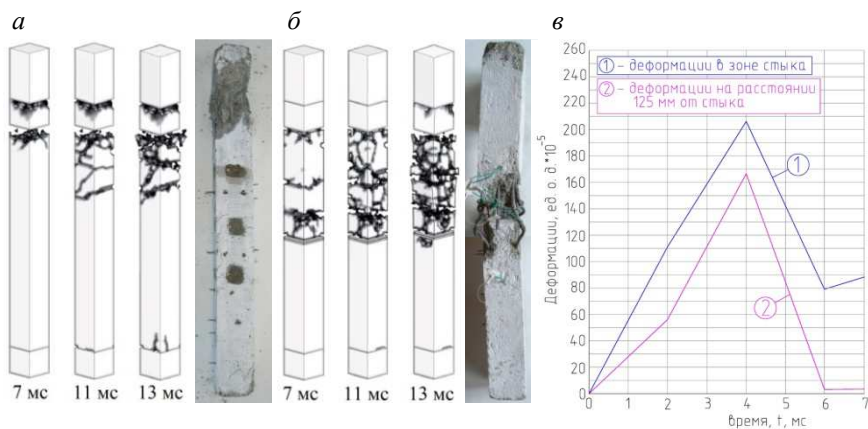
Деформирование, схемы трещинообразования и разрушения железобетонных колонн при динамическом нагружении по результатам численных расчетов и экспериментальных исследований (а – для колонны без стыка; б – для стыка колонн без усиления) и график зависимости поперечных деформаций бетона в уровне стыка в период динамического нагружения (в)
